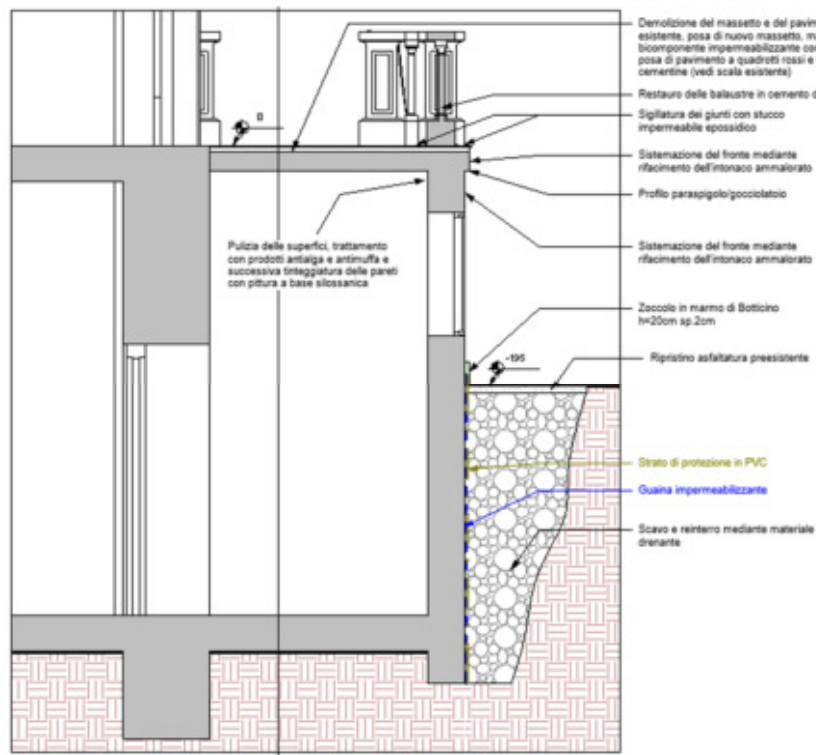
Restauro conservativo delle scale esterne 02 – Sezione B
